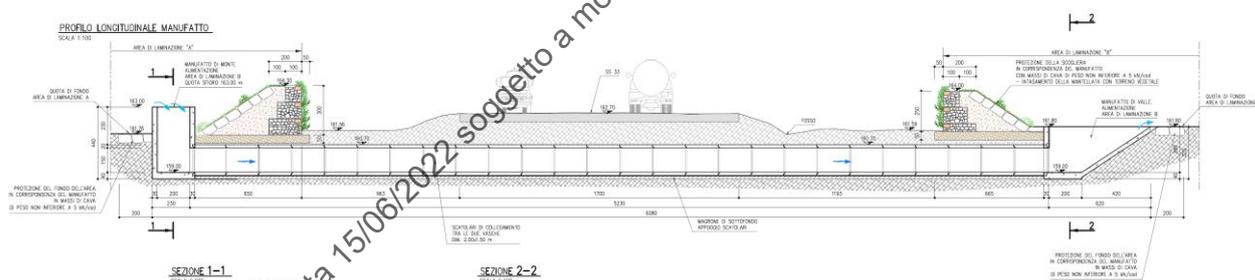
profilo longitudinale del sottopasso della SS33. Estratto da Tav. 13.1
